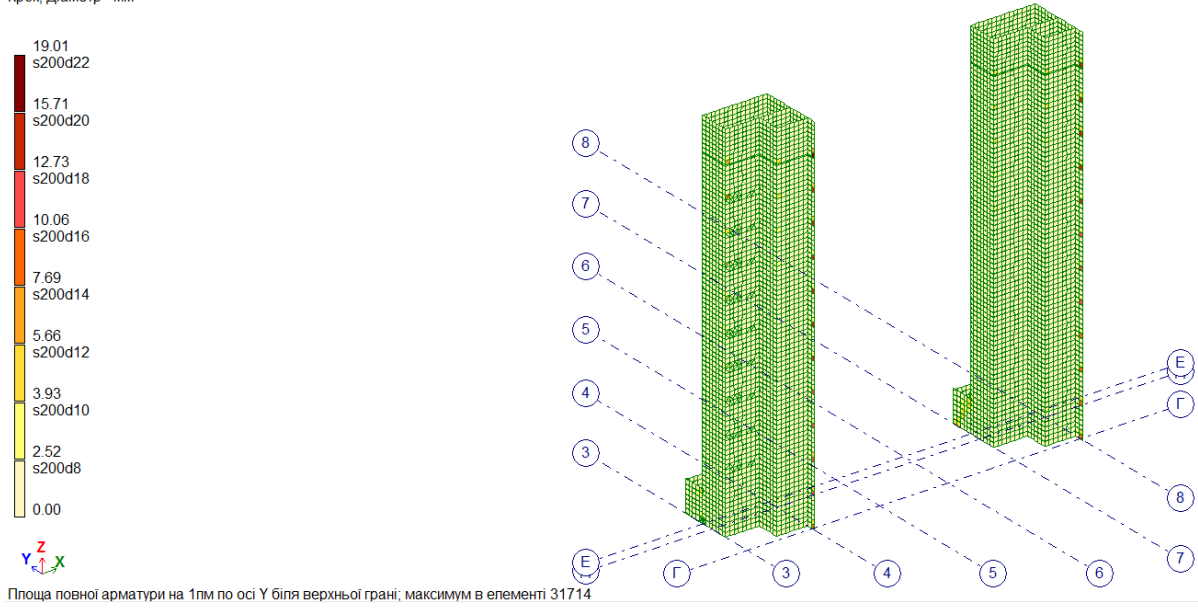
Ізополя розрахункового армування стін сходово-ліфтового блоку. Верхня арматура вздовж осі Y
